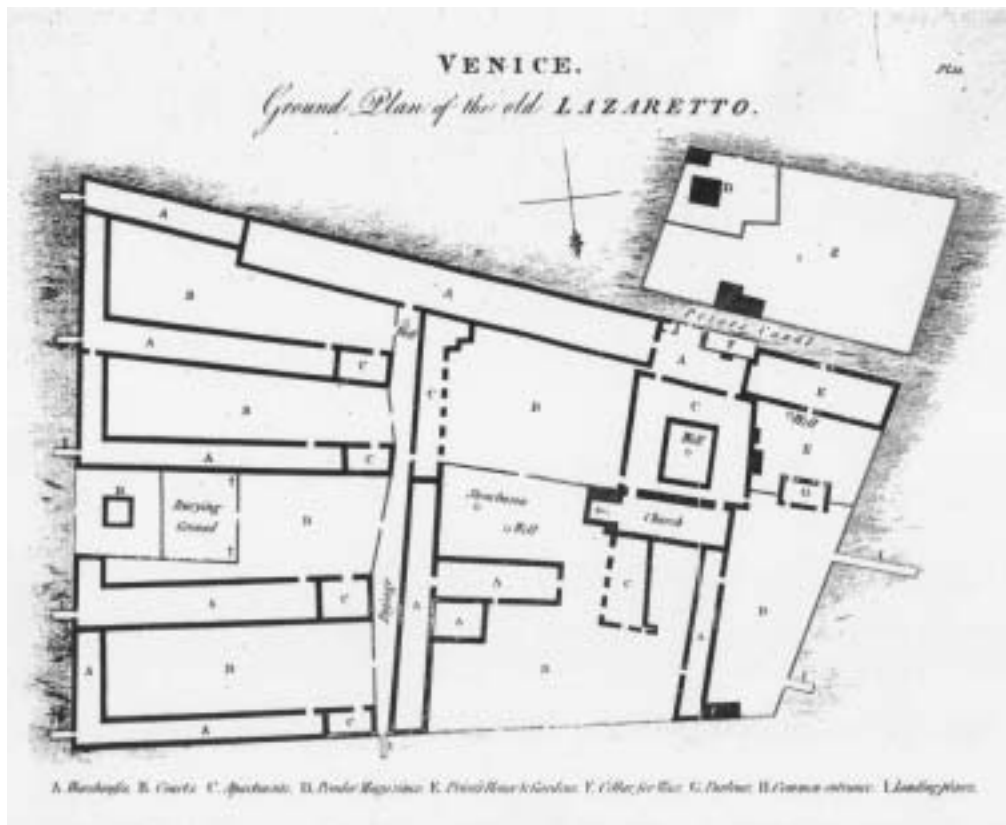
Venice. Ground Plan of the old lazaretto, planta, finales del siglo XVIII. En Howard, John. *An Account of the Principal Lazarettos in Europe...* London: Johnson, Dilly and Cadell, 1791, plancha 12
